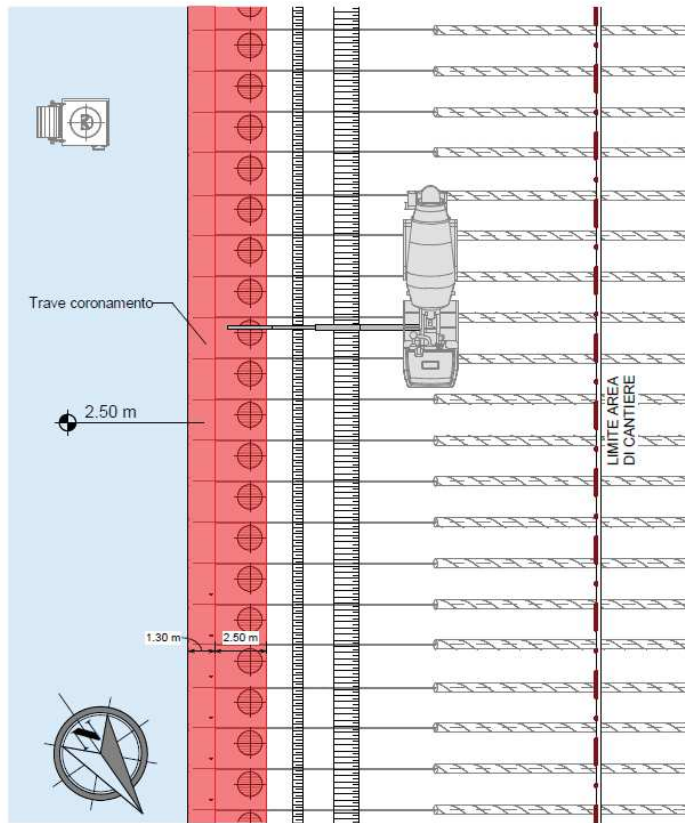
Planimetria con indicazione della trave di coronamento di progetto.
